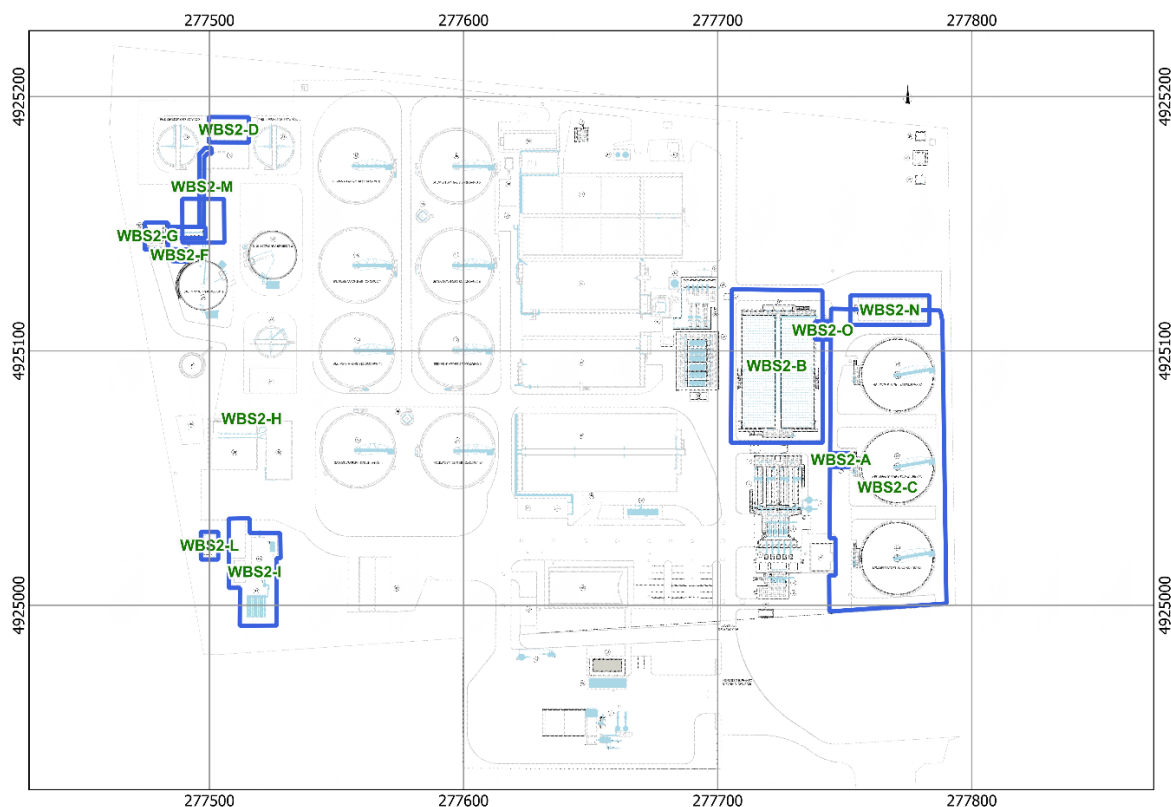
Posizionamento aree di scavo 2° stralcio lotto 2
